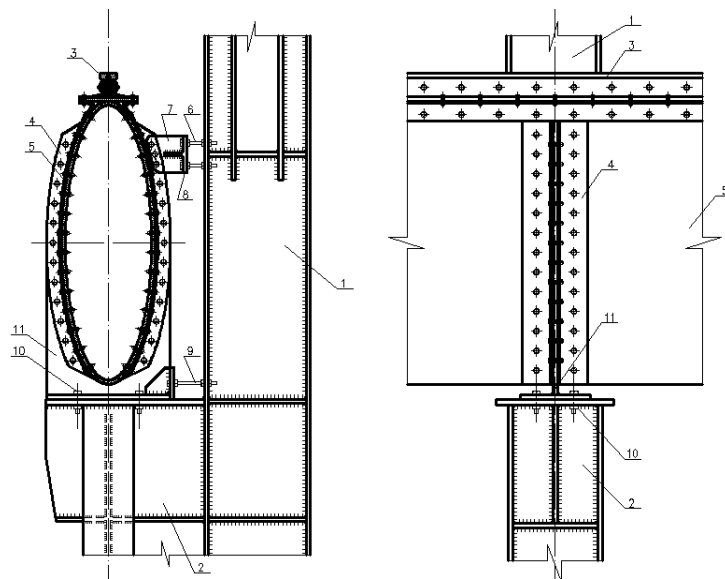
Узел крепления рельсобалочной конструкции к колонне, обеспечивающий рихтовку подкрановых путей: 1 – надкрановая часть колонны, 2 – подкрановая часть колонны, 3 – Рельсовый блок, 4 – соединительный уголок, 5 – балка эллиптического профиля, 6 – регулировочная шпилька, 7 – ребро жесткости, 8 – тавр, 9 – регулировочная шпилька, 10 – анкерный болт, 11 – опорное ребро
